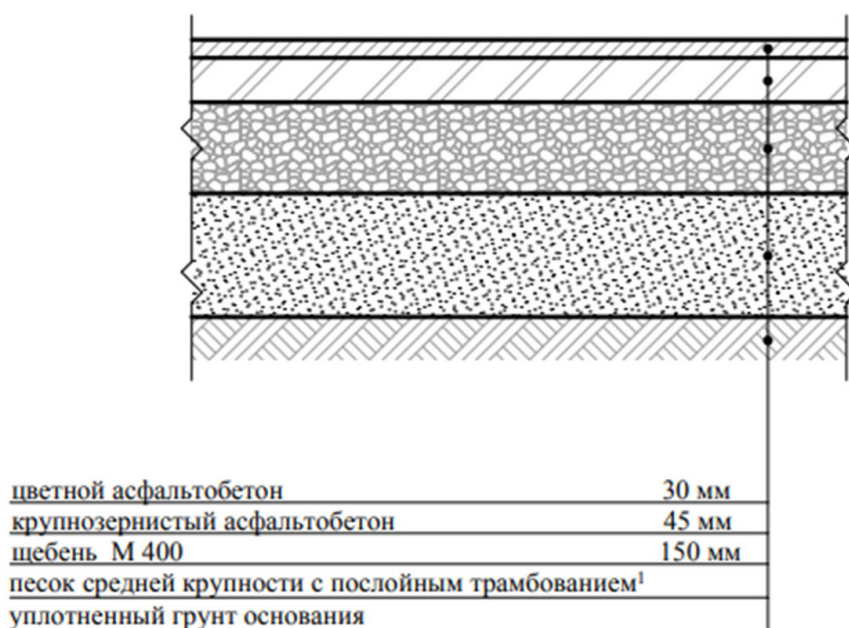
Асфальтобетонное покрытие велосипедной дорожки [4]
